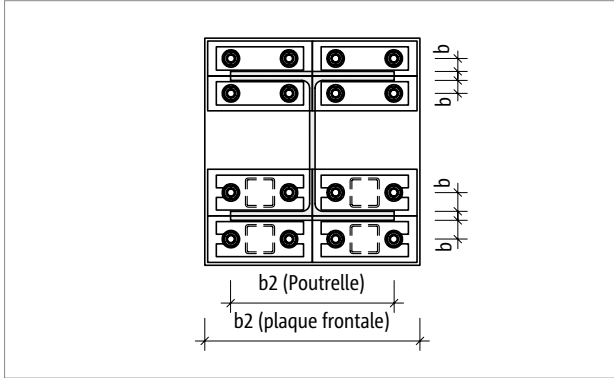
Plaque frontale T type S : tableau de valeurs de départ géométriques ; vue
